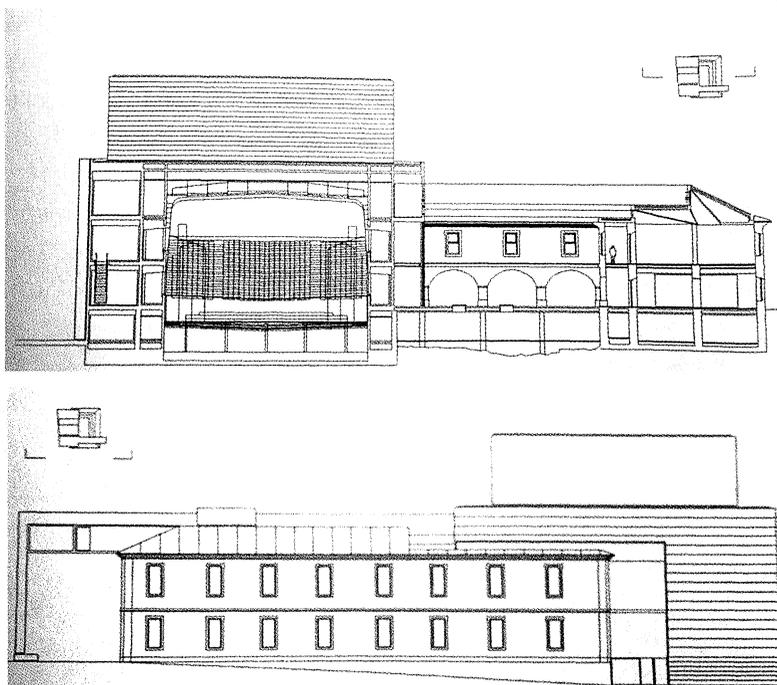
Planta de la biblioteca y alzado a la calle Quiroga Ballesteros.
